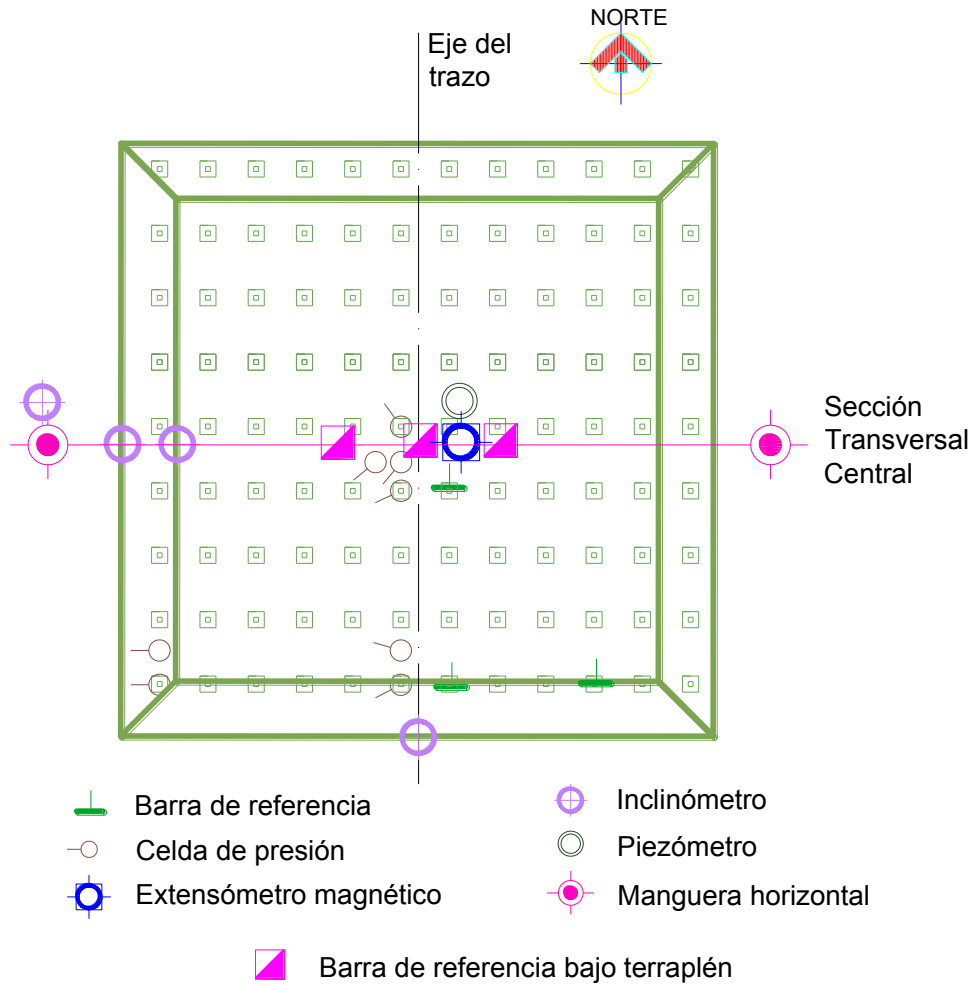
k.7 Esquema en planta y alzado del terraplén piloteado, incluyendo su instrumentación geotécnica
